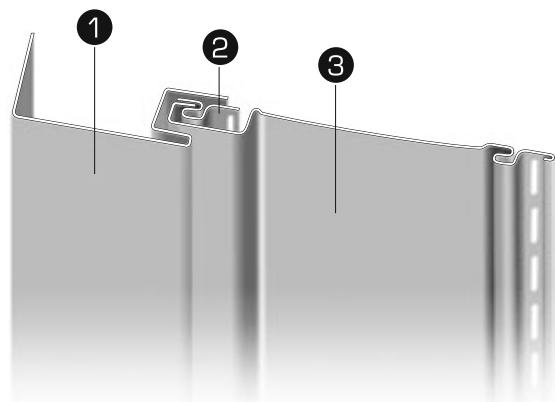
Схема установки панели сайдинга от углового элемента с помощью начальной планки: 1 – угловой элемент (наружный или внутренний угол); 2 – начальная планка; 3 – вертикальный сайдинг.
